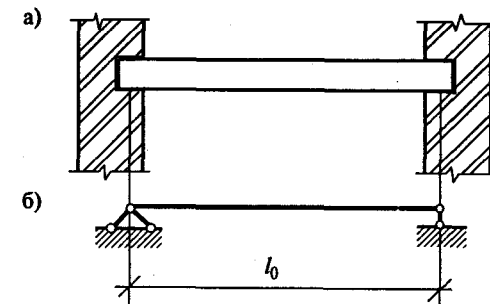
Вариант опирания железобетонной балки (плиты) на кирпичные стены: а) конструктивная схема; б) расчетная схема
